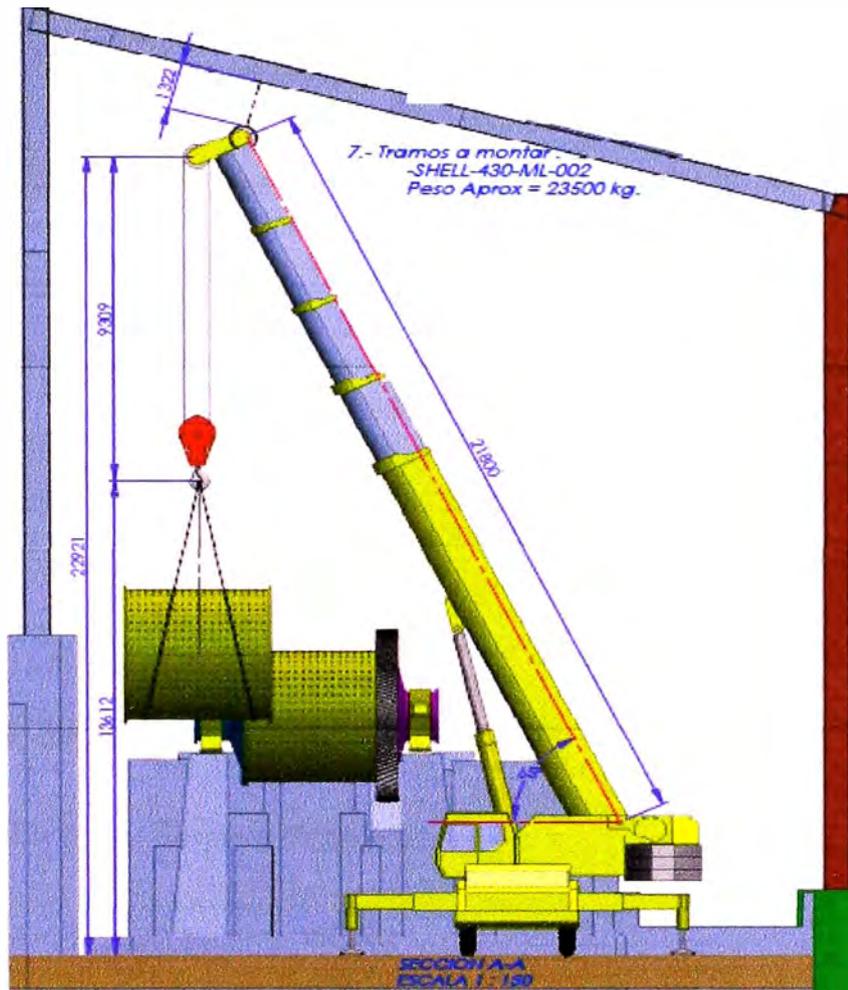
Vista frontal del rigging plan – montaje de shell
